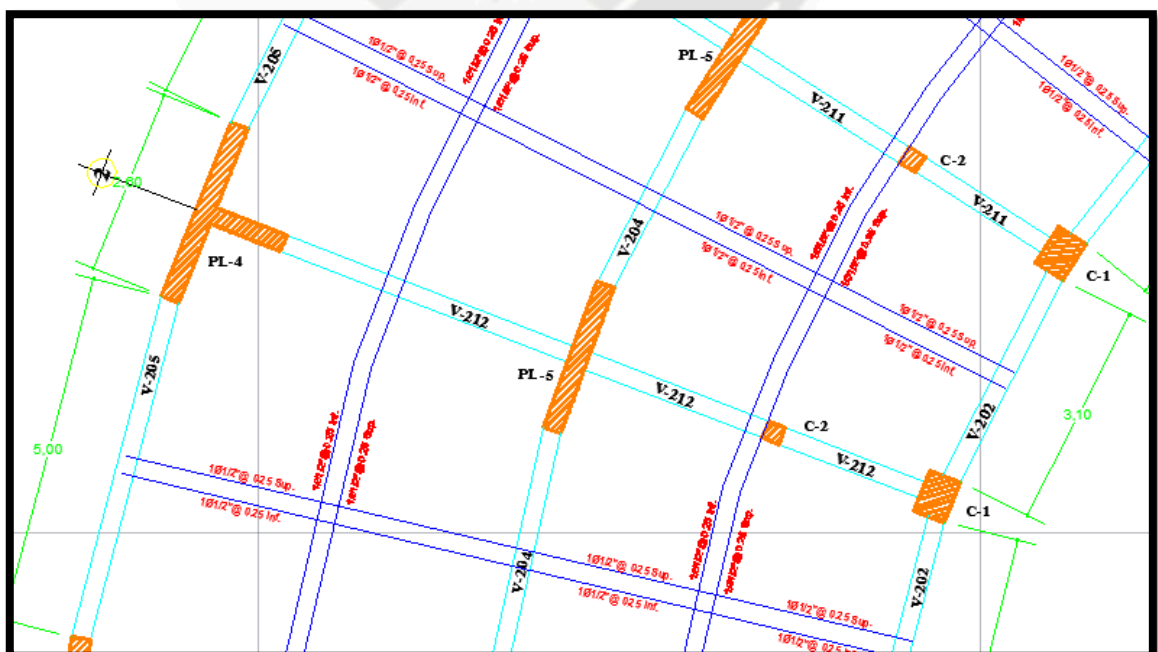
DETALLE DE ACERO LOSA MACIZA BLOCK B
